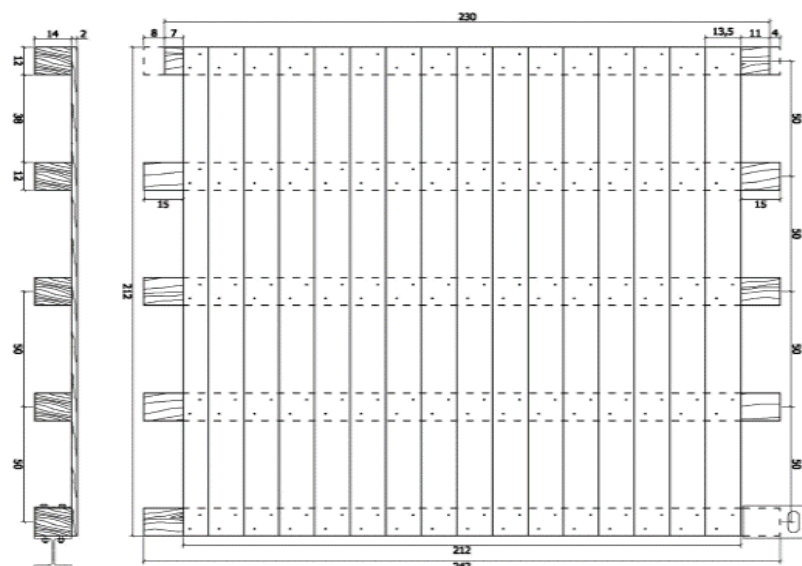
Dimensões das amostras do pavimento em centímetros [41].
